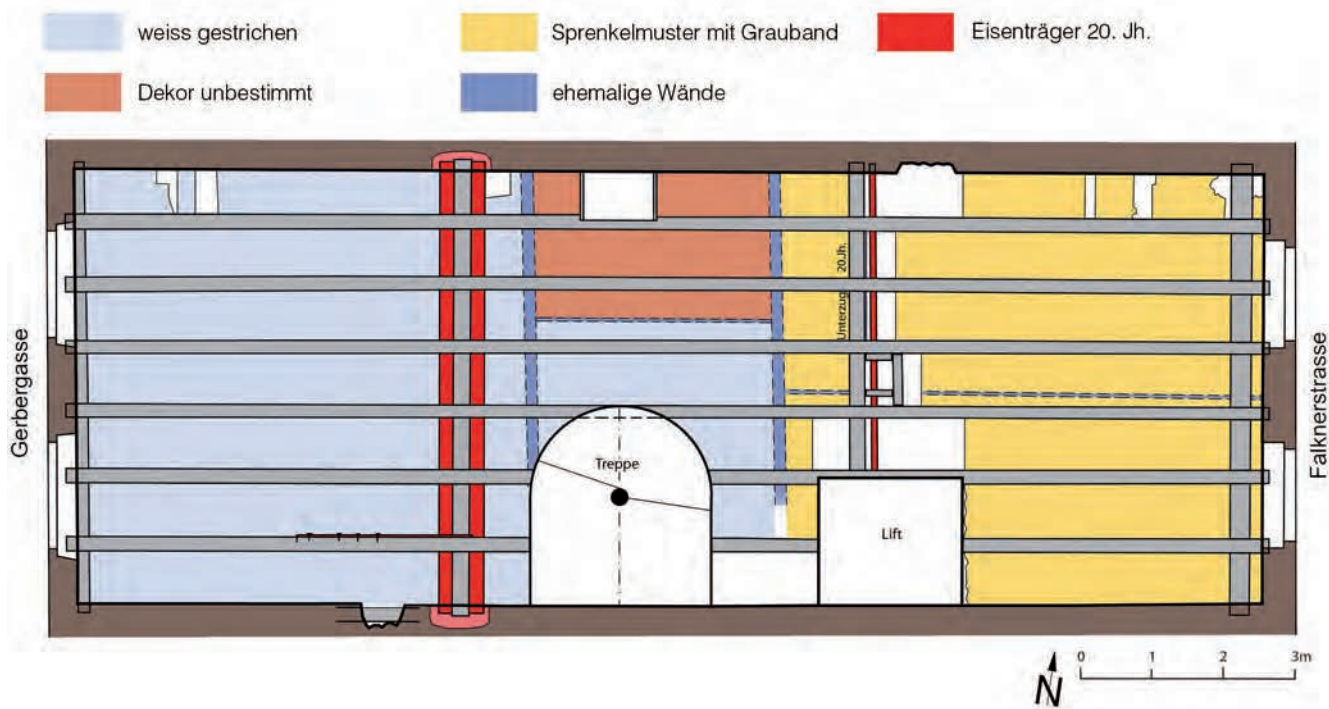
Gerbergasse 55. Grundriss 3. OG mit parallel zu den Brandmauern laufenden Deckenbalken, welche zugleich die Bundbalken des Dachwerks sind. Ursprüngliche Raumteilung im 17. Jh. – Plan: Stephan Tramèr
